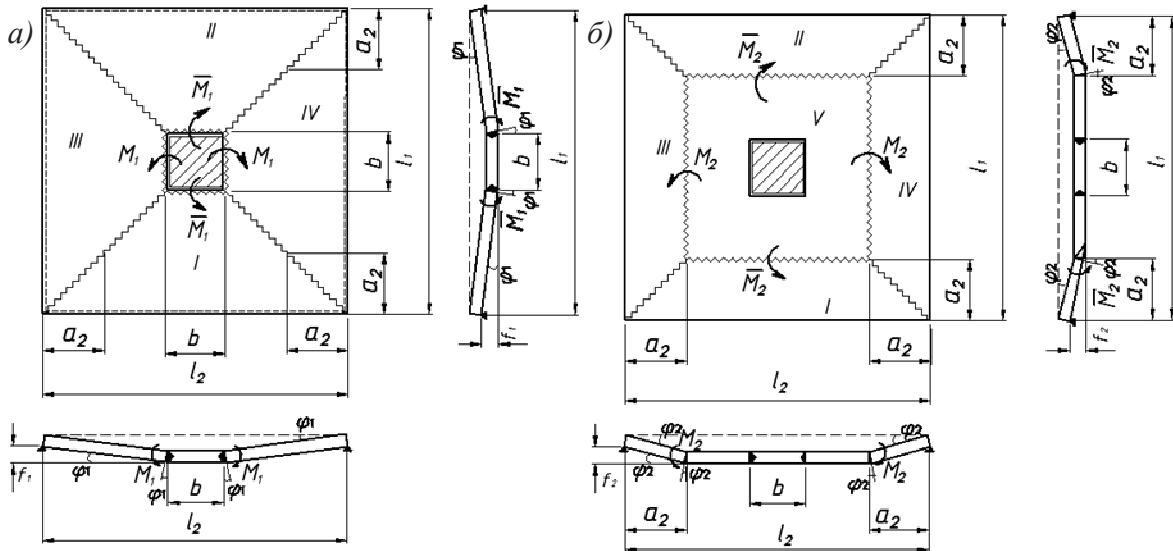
Кінематичні схеми руйнування надколонної плити:
